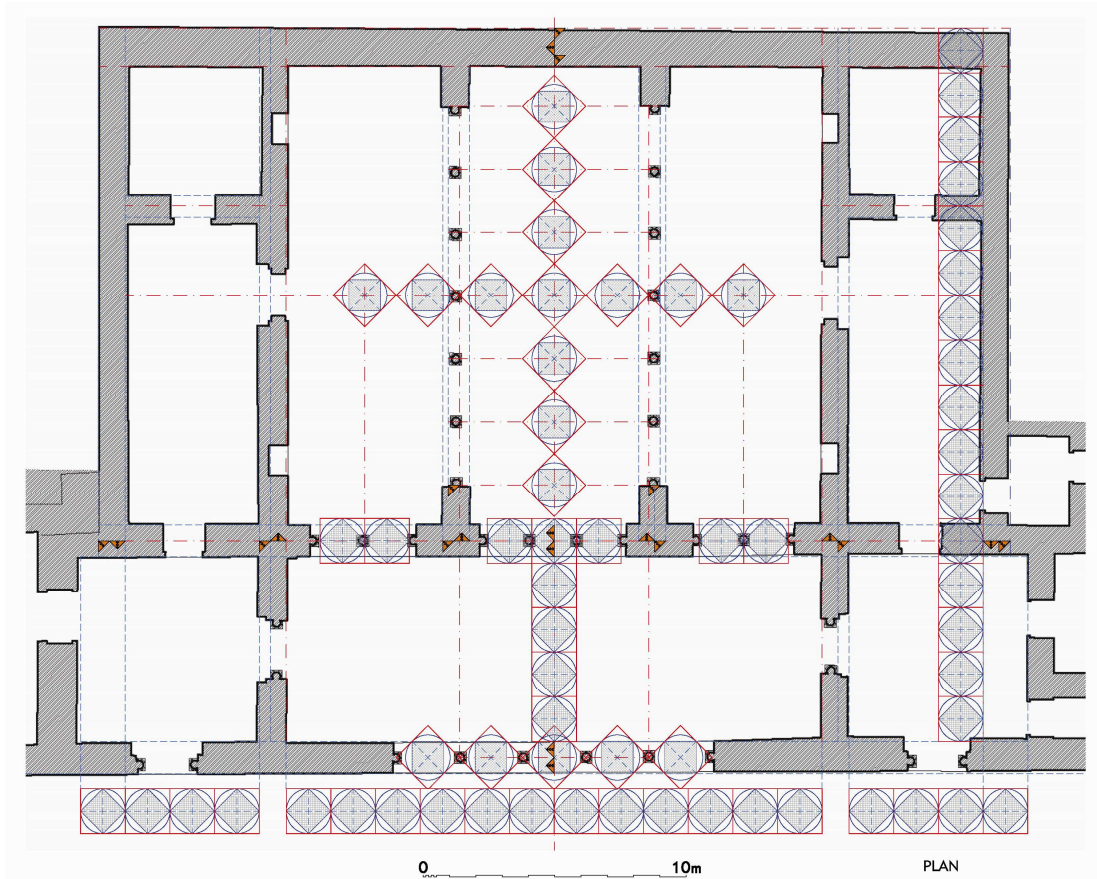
Modulación de la planta del Salón Rico de Medinat Al-Zahra
